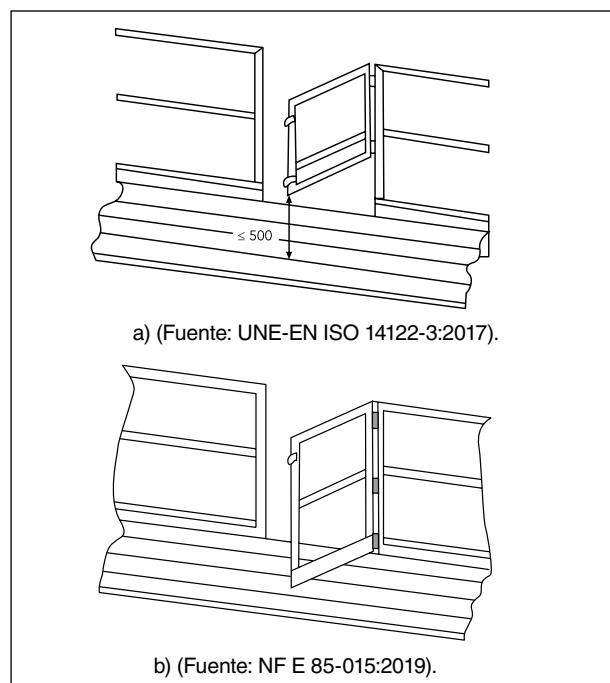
Puerta de cierre automático (abierta hacia la plataforma).⁶
